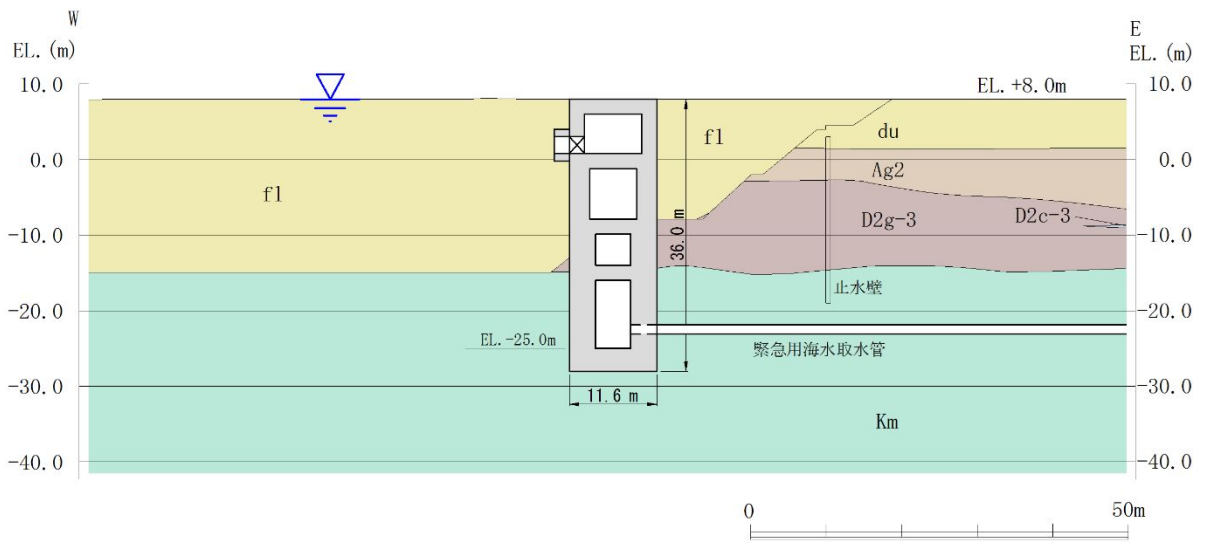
(1) 緊急用海水ポンプピットの評価対象断面図 (東西方向断面)
